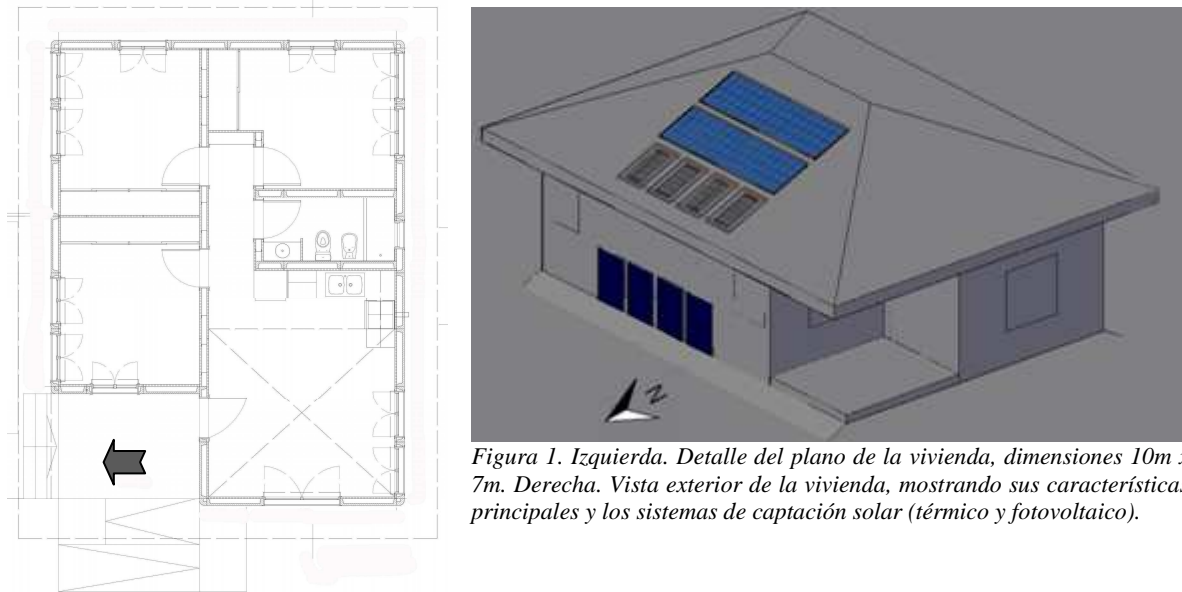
Izquierda. Detalle del plano de la vivienda, dimensiones 10m x 7m. Derecha. Vista exterior de la vivienda, mostrando sus características principales y los sistemas de captación solar (térmico y fotovoltaico).
